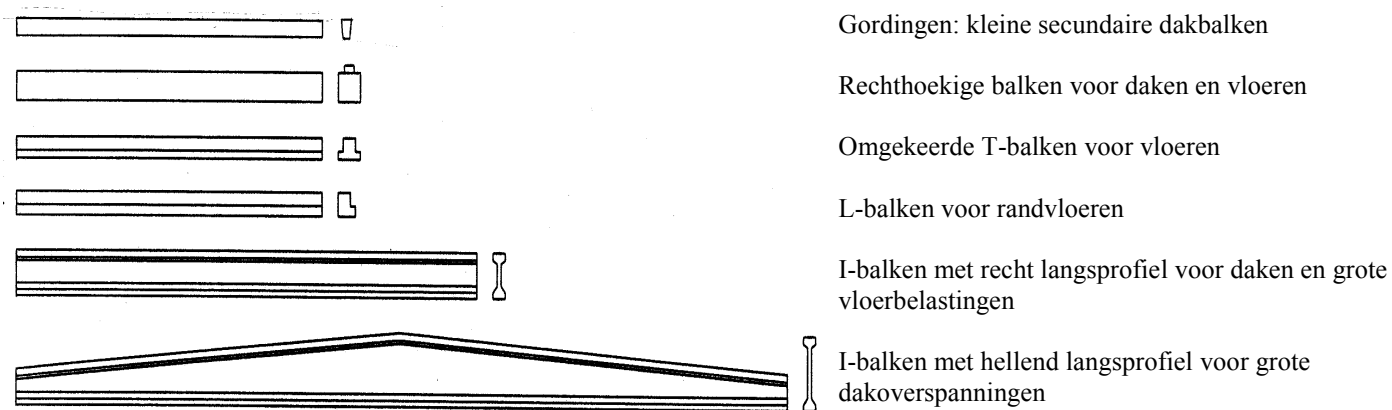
Overzicht van types van geprefabriceerde balken
